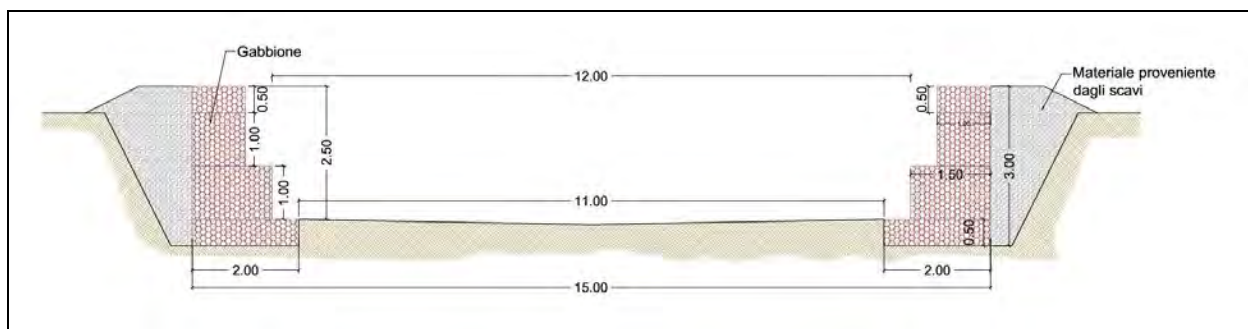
Sezione tipo (da sez. 5.29 a sez. 5.02)
